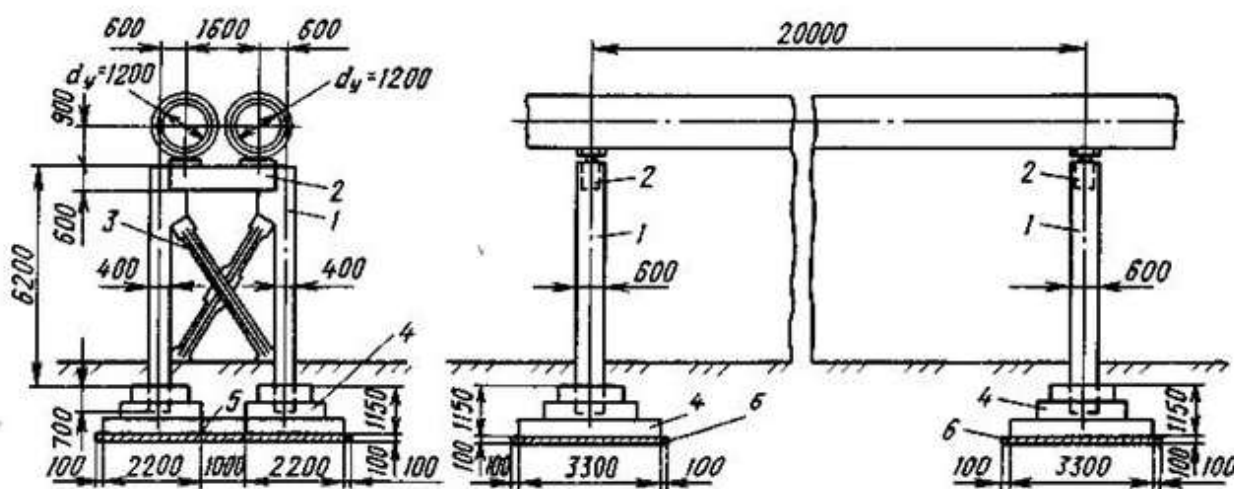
, прокладка трубопровода на железобетонных мачтах:
